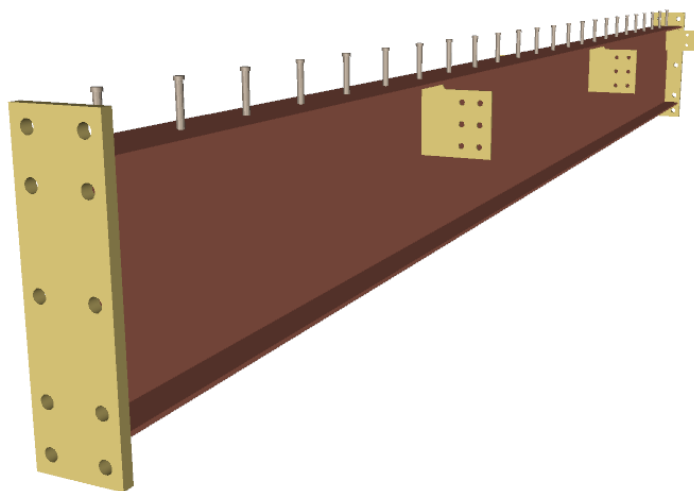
Chapa de topo e chapa corte soldado em viga
